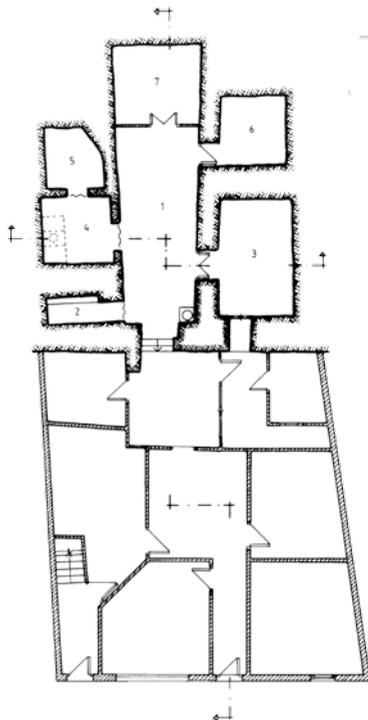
Plano de planta de vivienda-cueva con construcción delantera. Situada en C/ Vereda Hospital. Fuente: (García Aznar y López Davó 2000).
